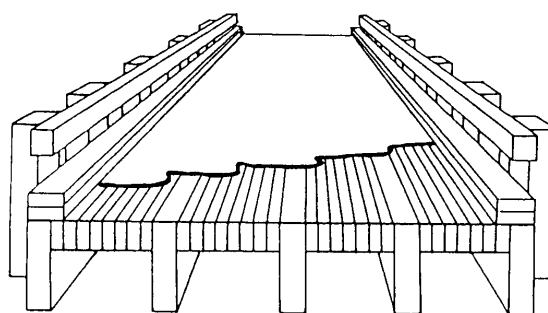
Ponte de madeira com vigas T (Fonte: OKIMOTO, 1997)
